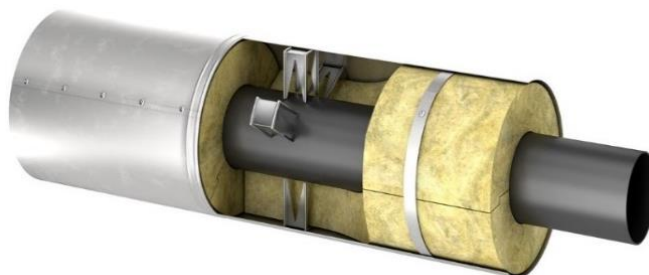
Система теплоизоляции трубопроводов ТН-ТЕХИЗОЛЯЦИЯ
